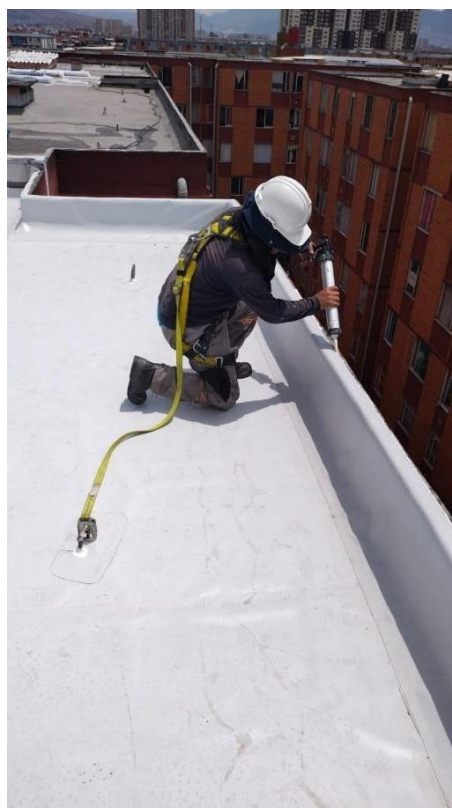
Instalación de geotextil en placa (Porvenir)
